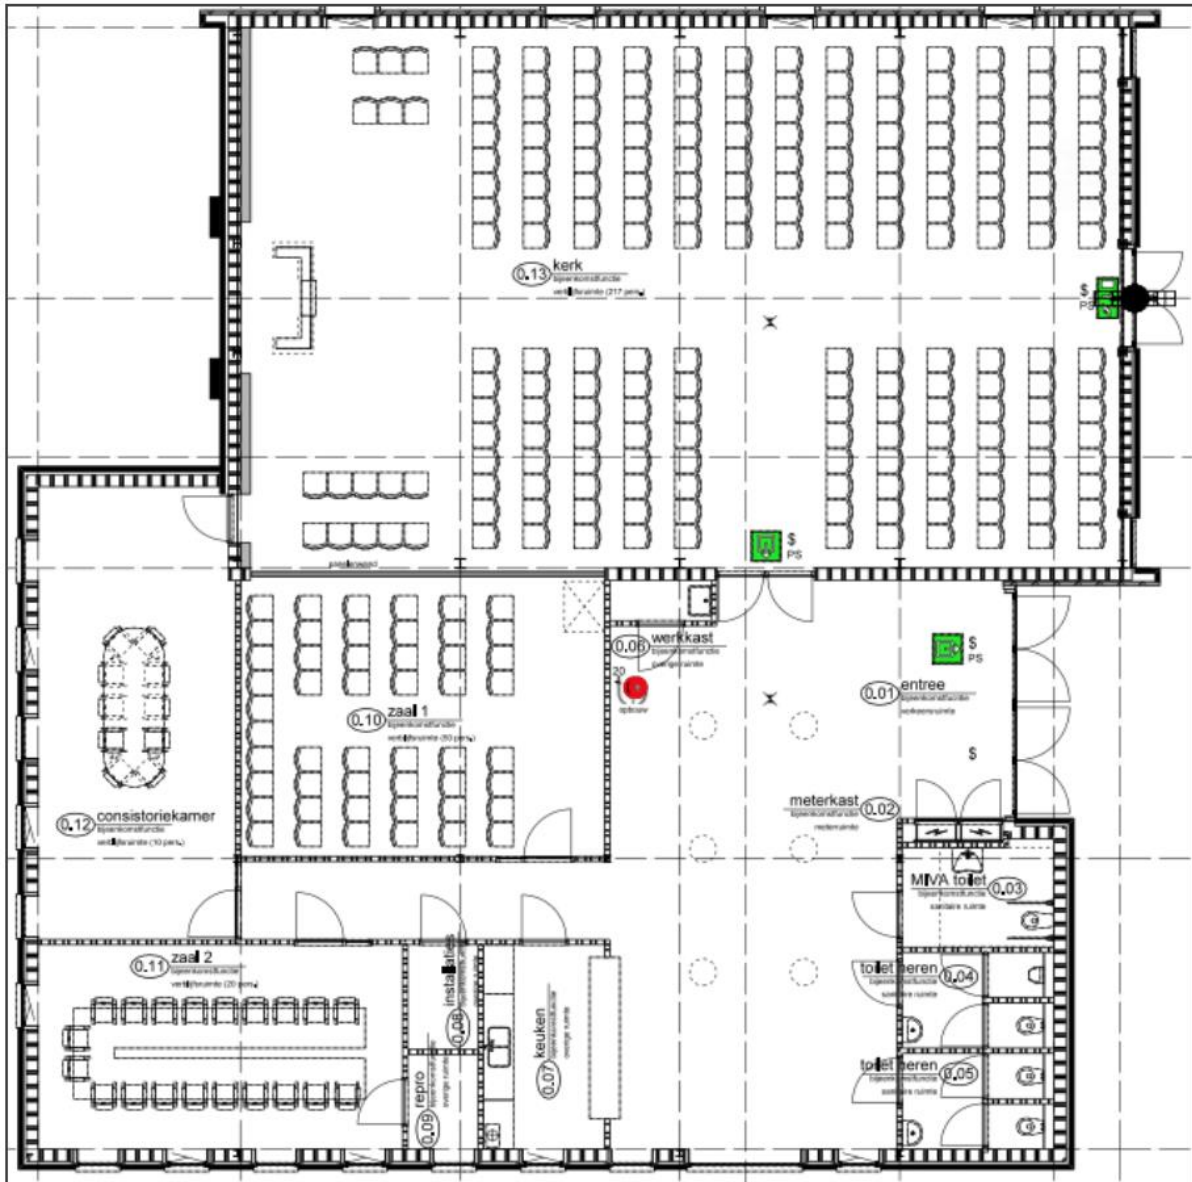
Plattegrond gewenste ontwikkeling (Bron: Huls Architecten)
